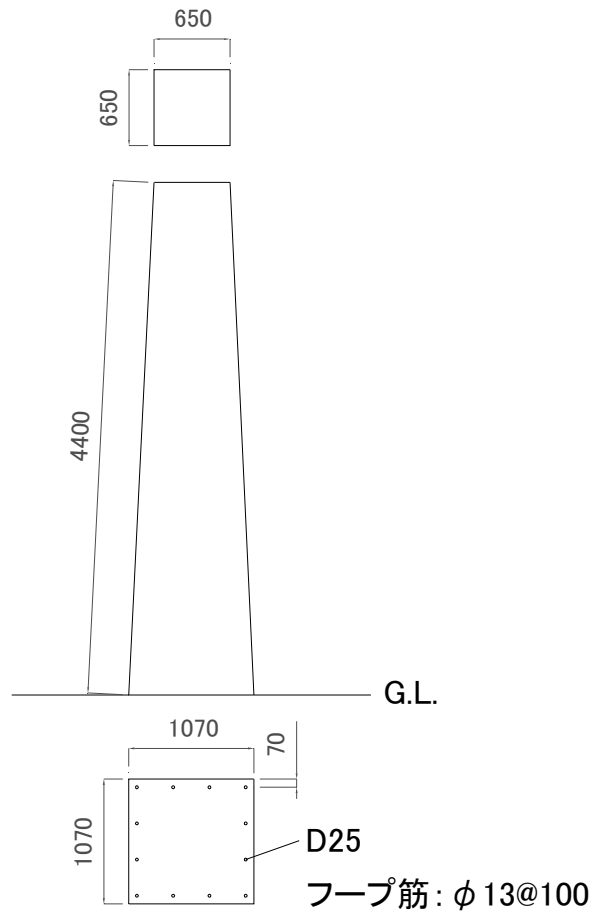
RC 柱の立面図・断面図 (単位: mm)
